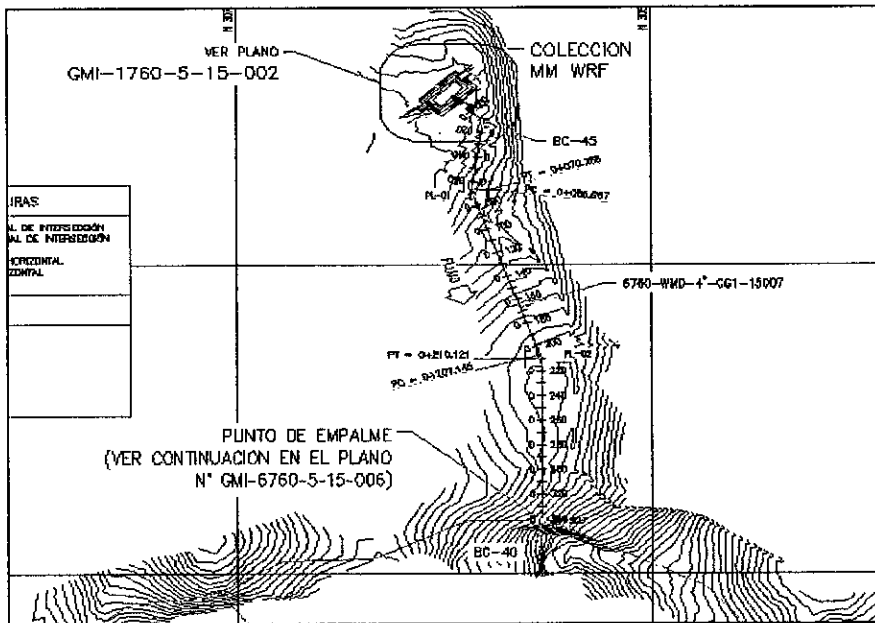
Ruta de pipeline desde la zona Maqui Maqui Spring a hasta el empalme con la Línea de Maqui Maqui Spring, dentro del plano de construcción PLANO GMI-6760-5-15-007
